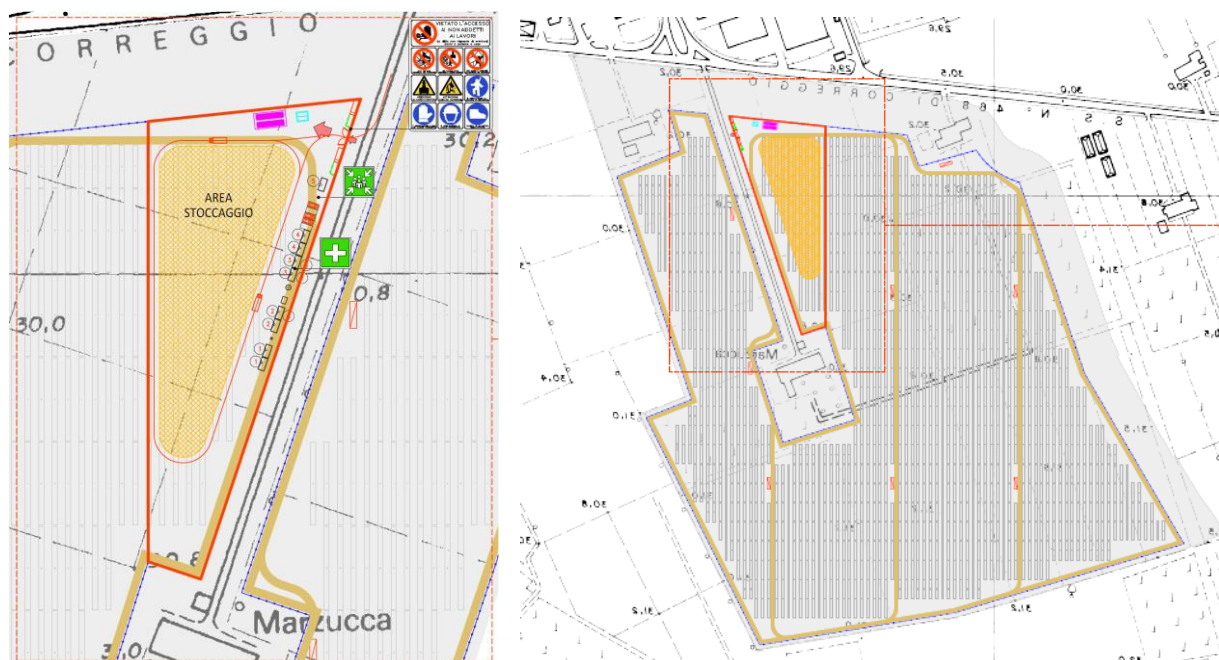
Stralcio delle aree di stoccaggio di cantiere.
